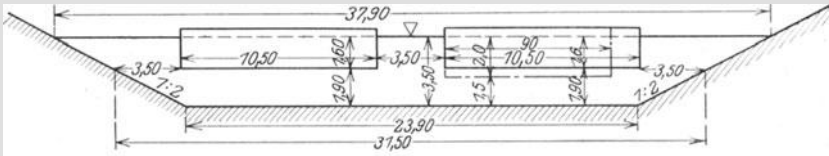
Trapezförmiger Kanalquerschnitt. Maßstab 1 : 400.
